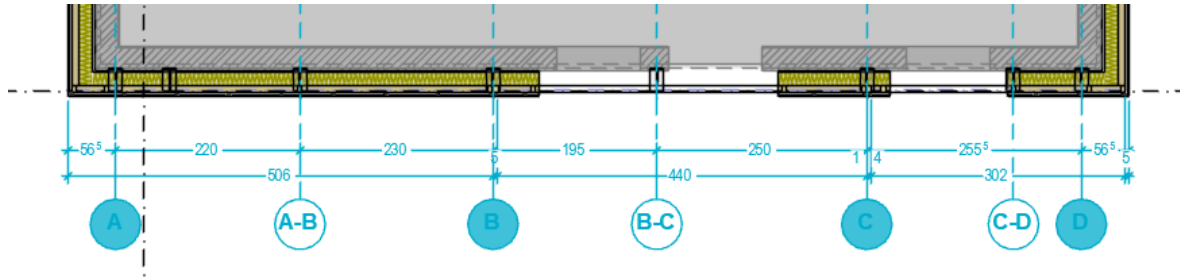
/ Grundriss vor Montage Fenster- Türelemente
